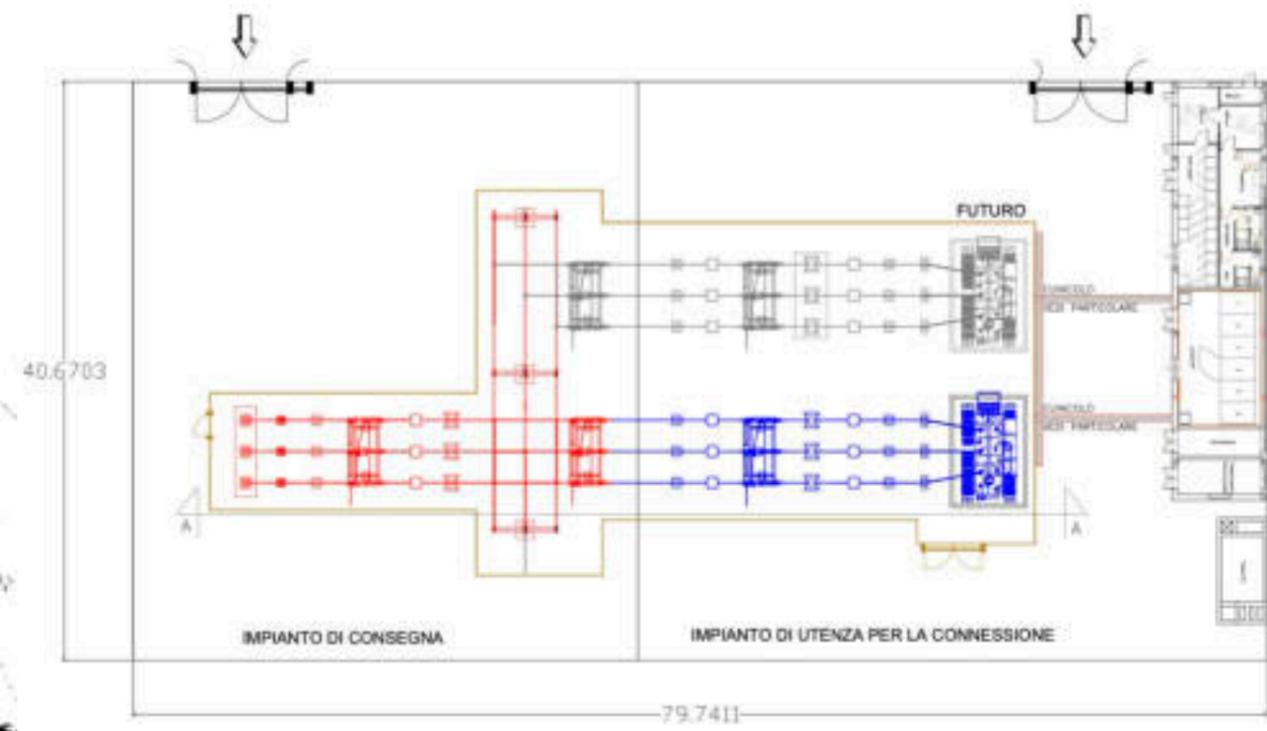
SOTTO STAZIONE ELETTRICA: LOCALIZZAZIONE E PIANTA (dalla Relazione generale EGM Project)
